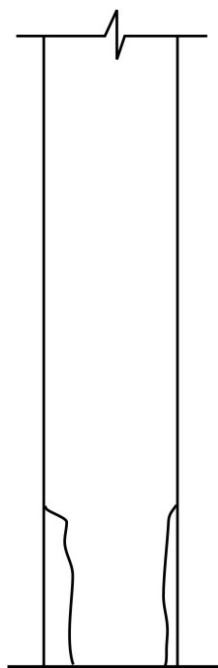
Típica forma de fissuras e lascamento em pilar de concreto paralelamente às armaduras verticais. Geralmente estas fissuras são acompanhadas pelo destacamento da camada de proteção. (HELENE, 1993).
